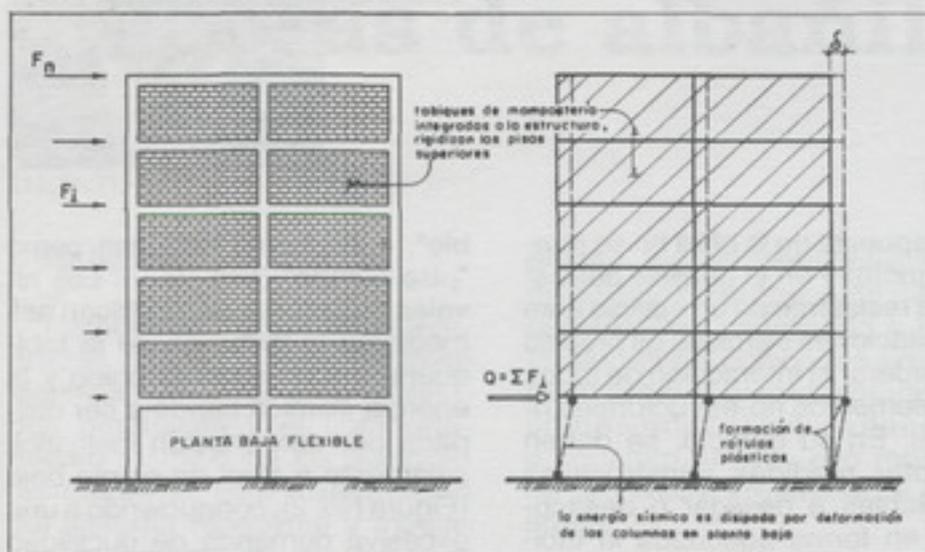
Edificio con planta baja flexible y pisos superiores rigidizados por mampostería. La energía sísmica es disipada por deformación de las columnas de la planta baja, pudiendo conducir a un mecanismo de colapso.
